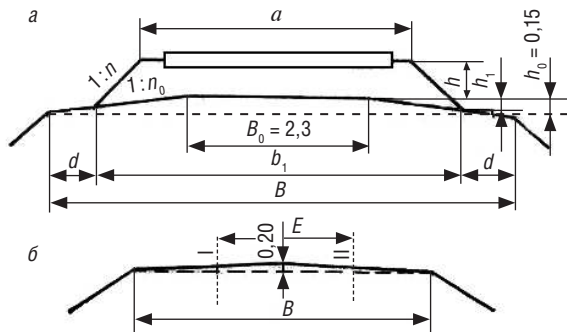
Поперечное очертание основной площадки земляного полотна для однопутных (а) и двухпутных (б) линий
